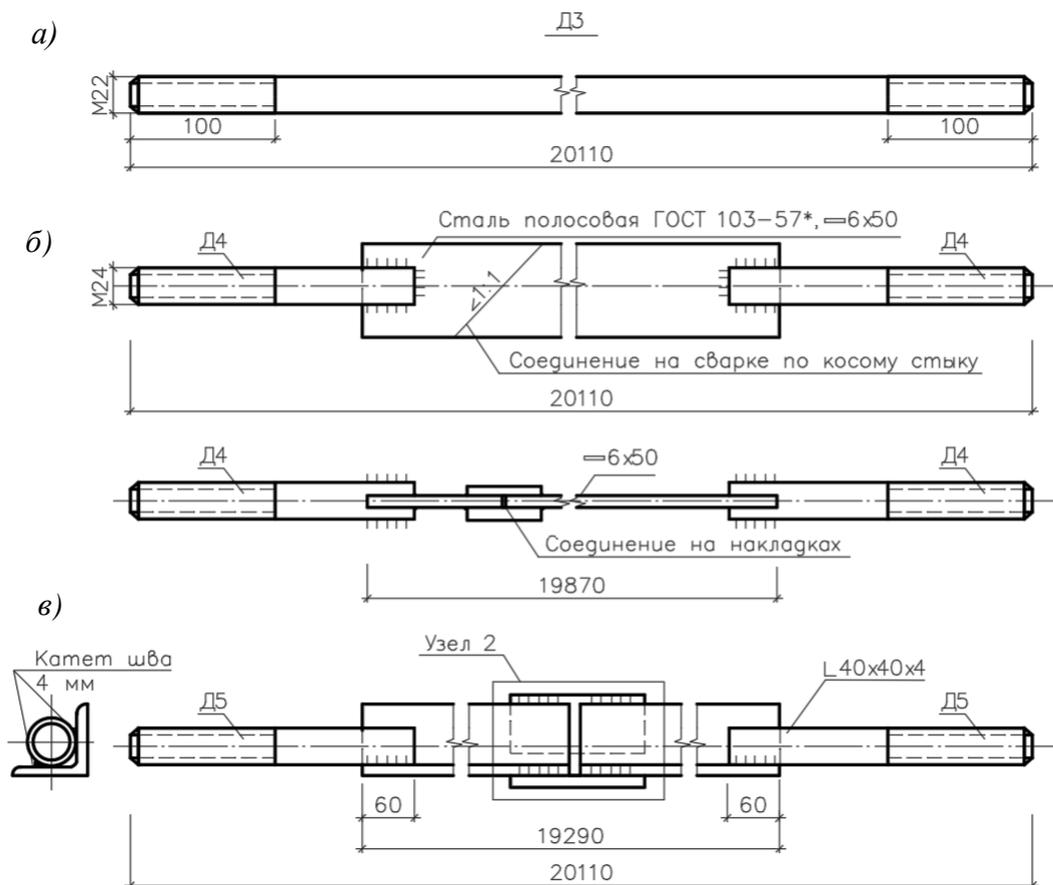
Виды затяжек для первого варианта усиления нижнего пояса фермы: а – тяж круглого сечения; б – стальная полоса; в – металлический уголок
